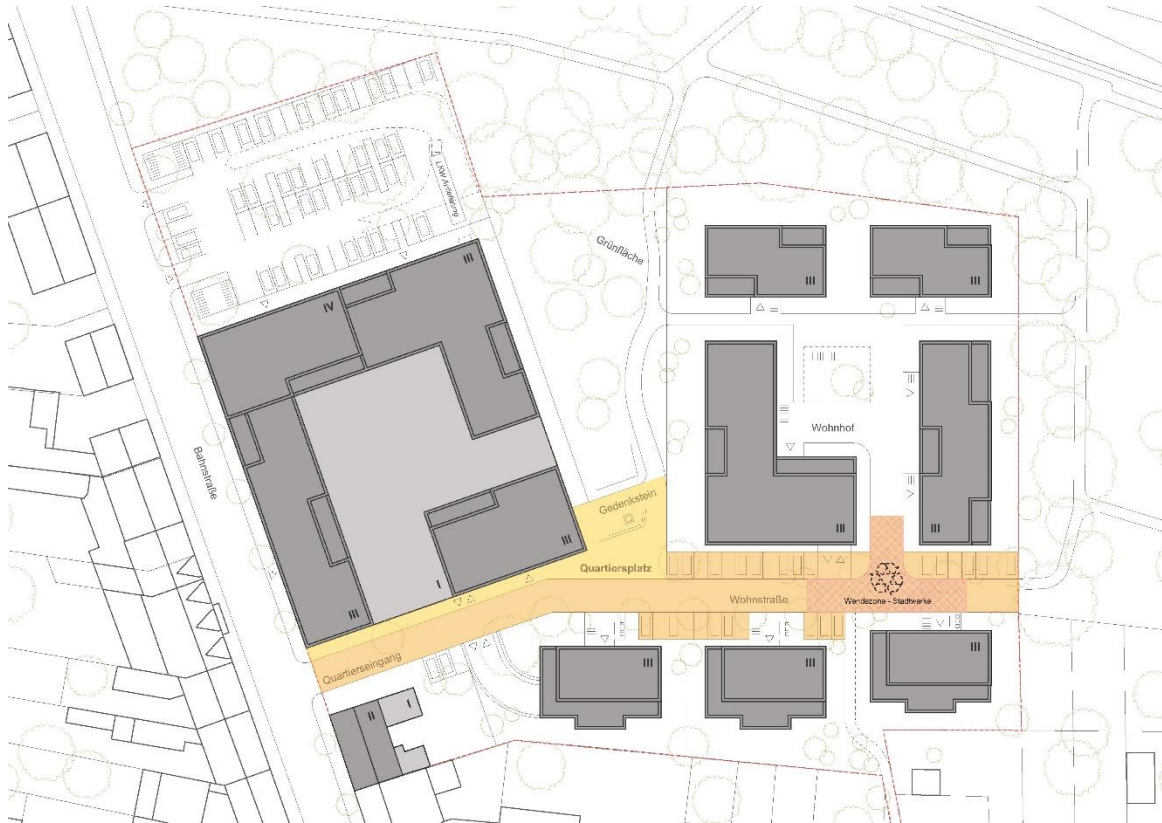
Rahmenplanung | Öffentliche Erschließungsflächen © LECKE ARCHITEKTEN
